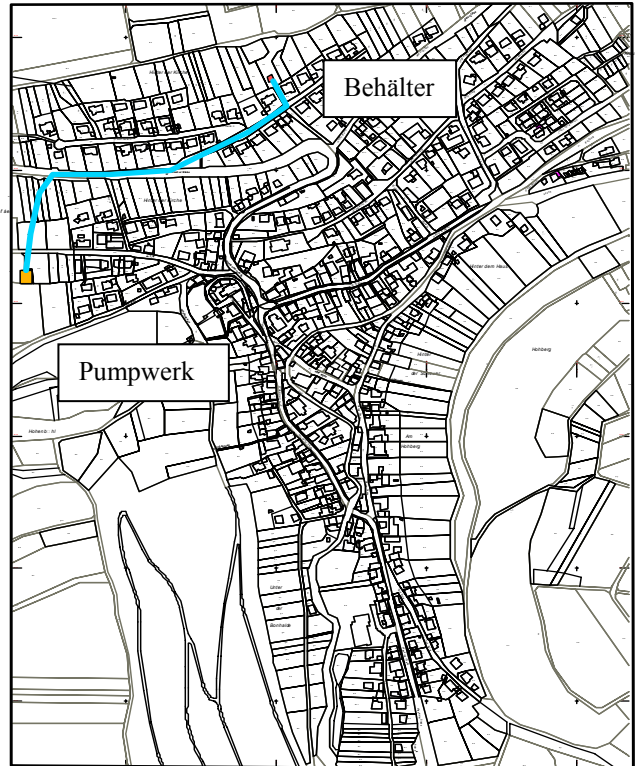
Bestehende Versorgung Pumpstation und Behälter mit Zuleitung
